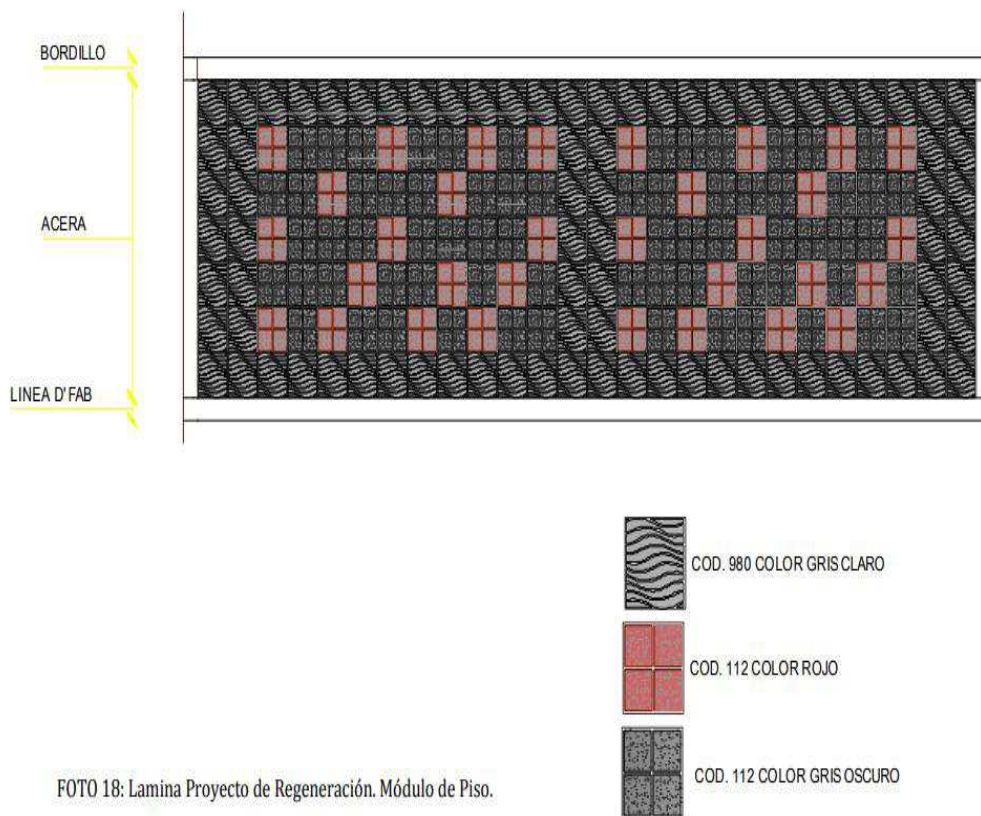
Lamina Proyecto de Regeneración. Módulo de Piso.
